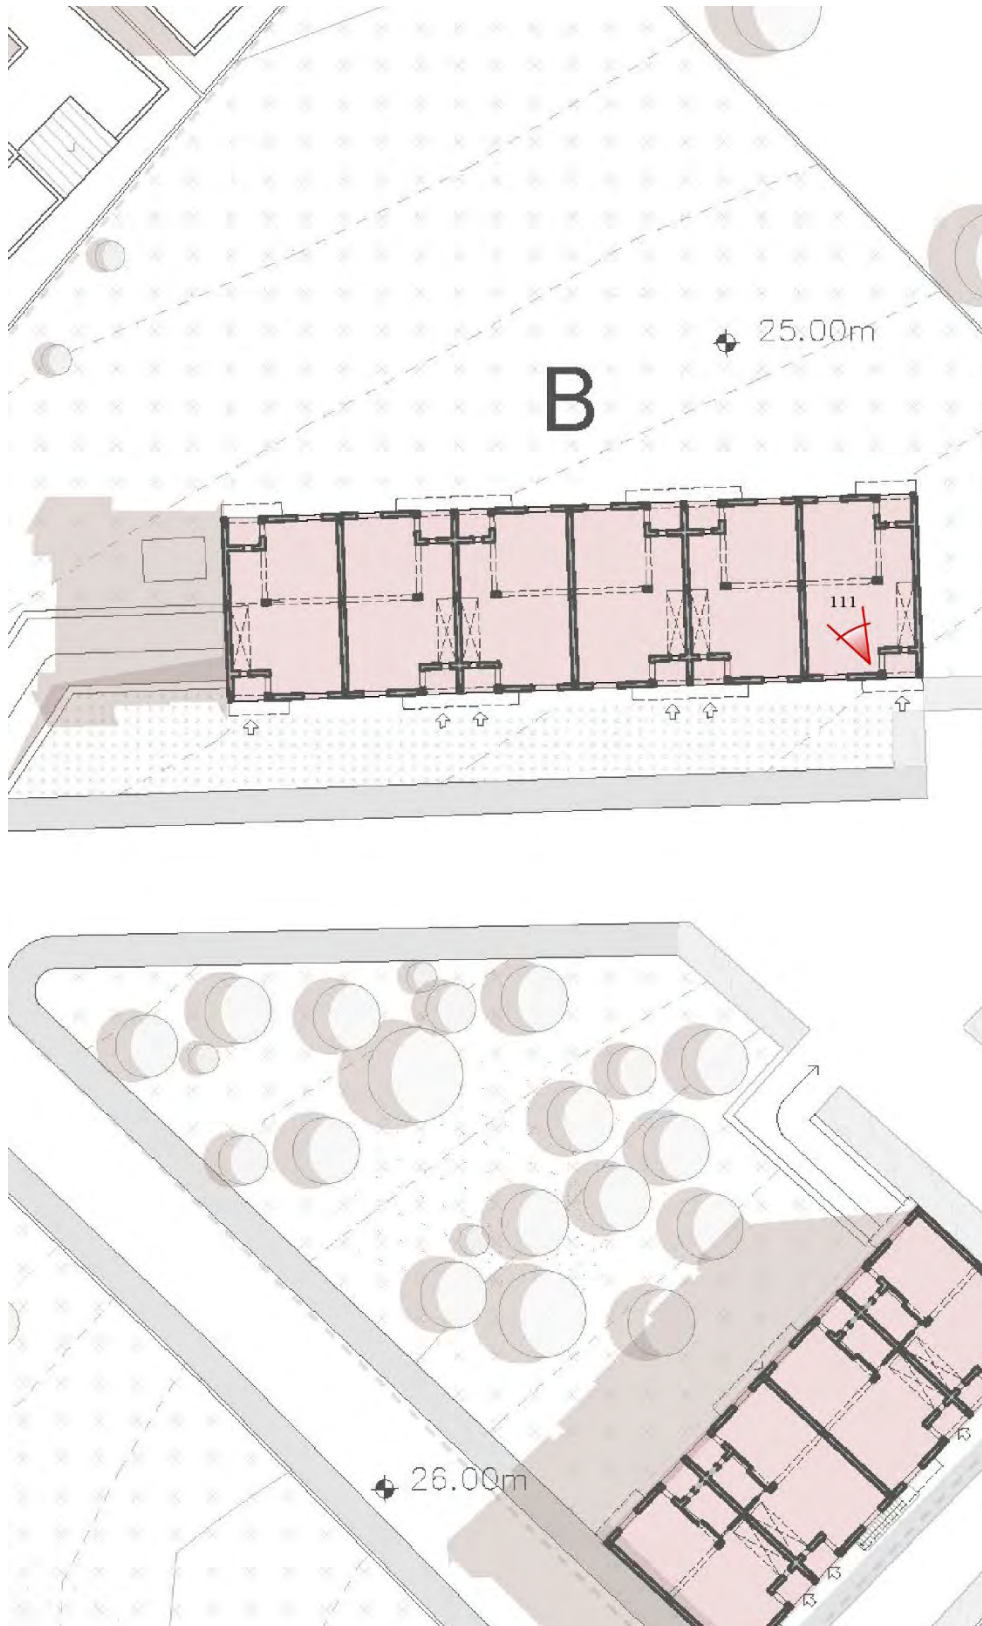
| Pianta edificio B con indicazione punto di applicazione sensori (credit: L. Cantoni; edit: F. Anania)
